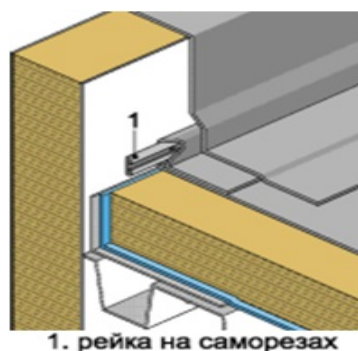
Крепление с помощью крепежных элементов и металлической рейки
